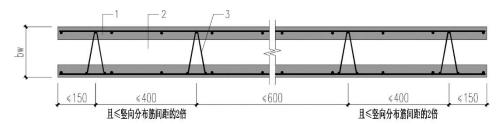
双面叠合墙板钢筋桁架布置示意图
